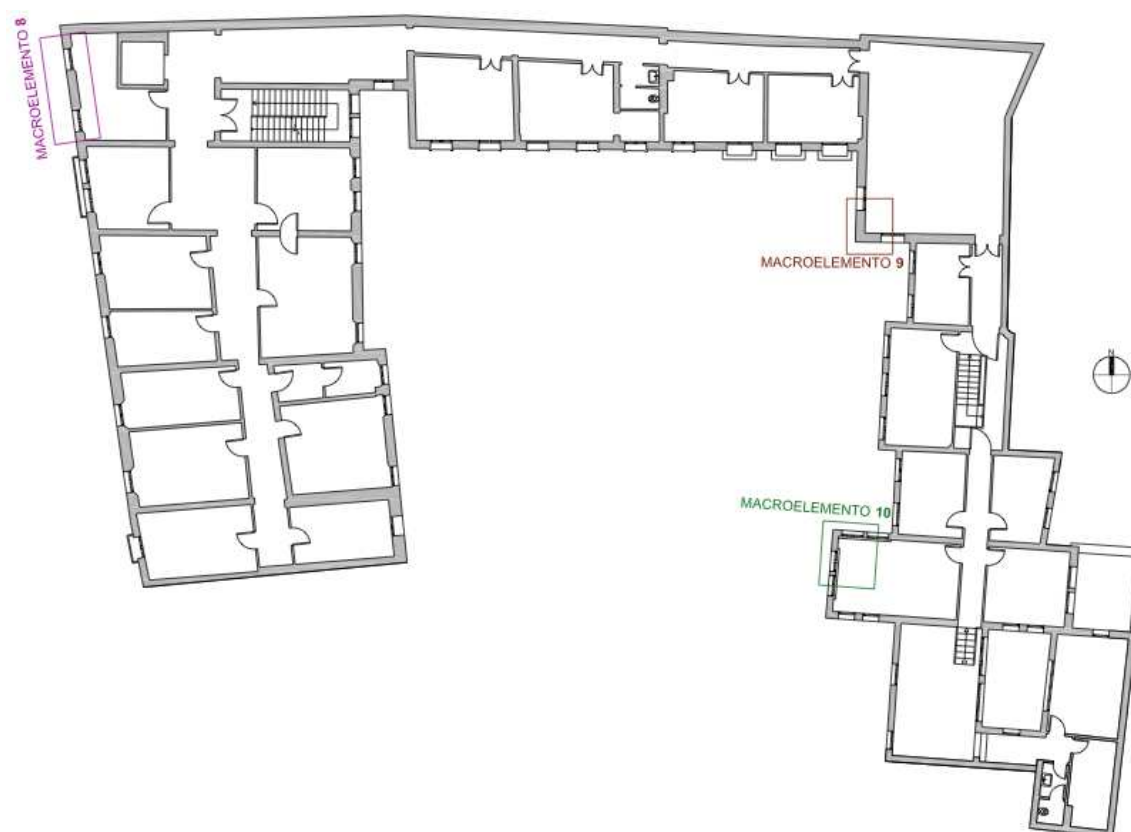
Localizzazione dei macroelementi, pianta piano primo
